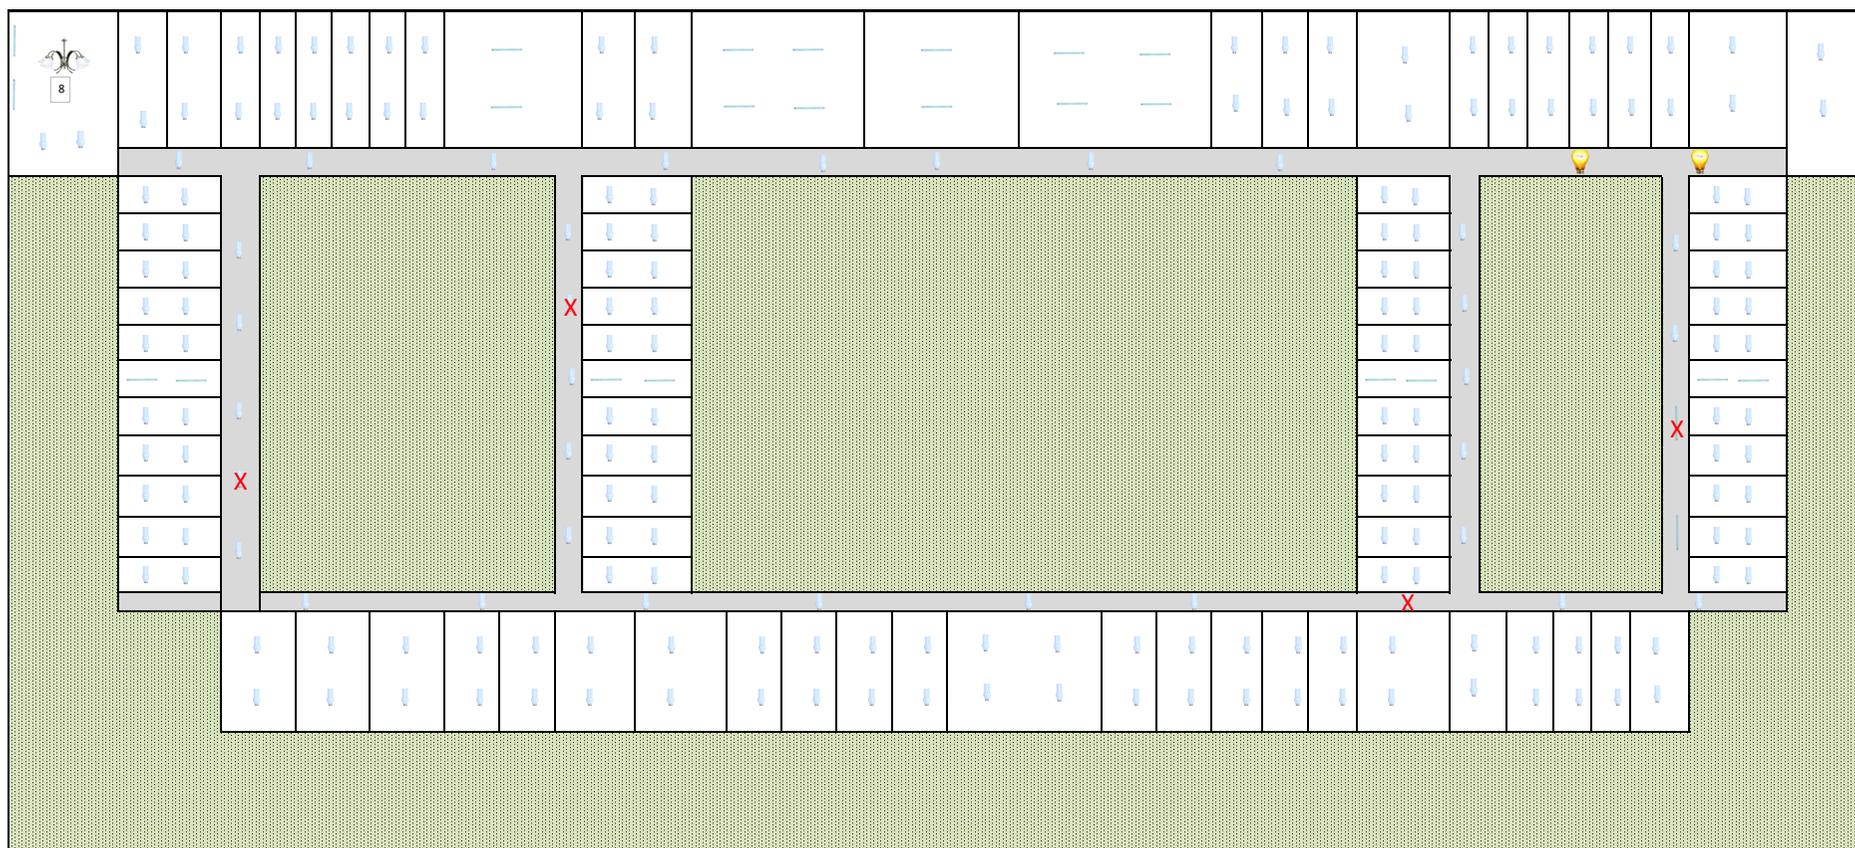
Distribución de las luminarias en la segunda planta de la institución.
